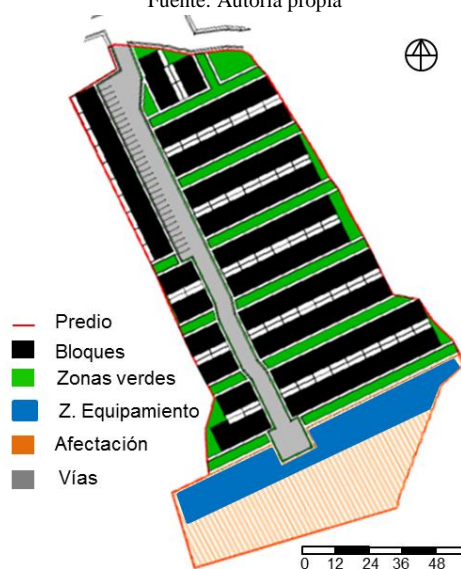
Ubicación en el territorio, Piedras. Autoría Propia.
